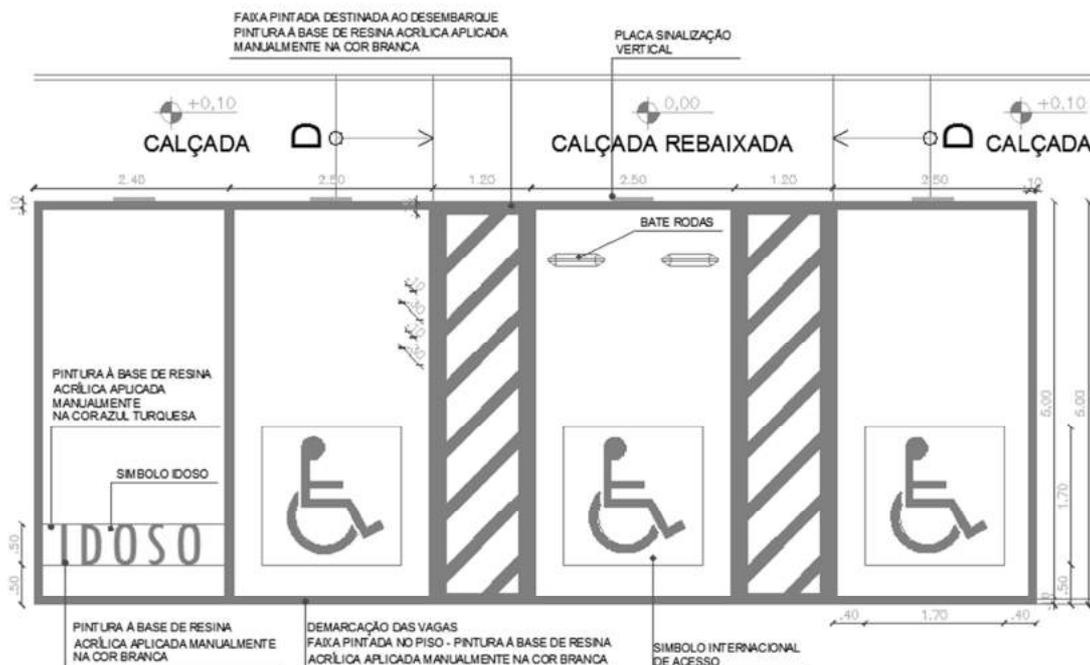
MODELO DE VAGAS RESERVADAS E ACESSOS – PLANTA
